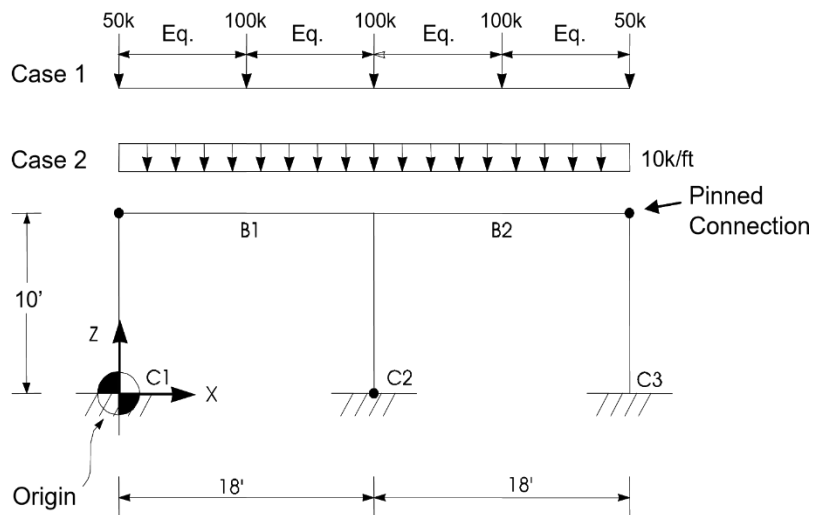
Marco Plano con Cargas de tramo de viga.
